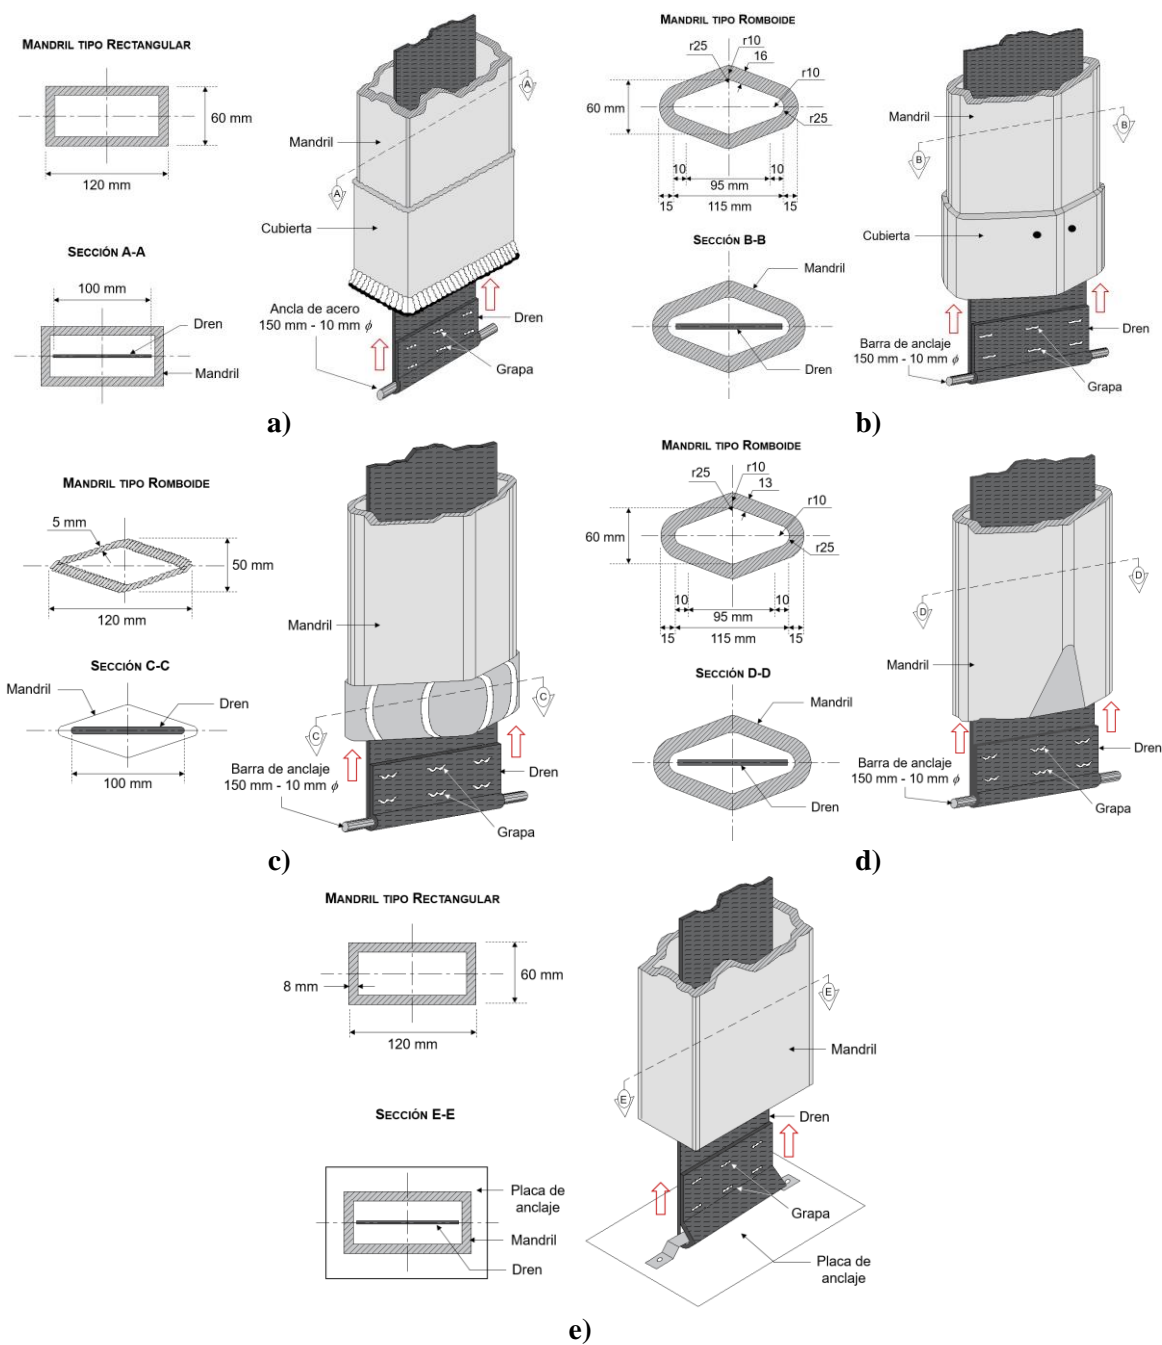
Tipos de mandril y anclajes de drenes verticales prefabricados (modificado de Bo et al., 2015).
